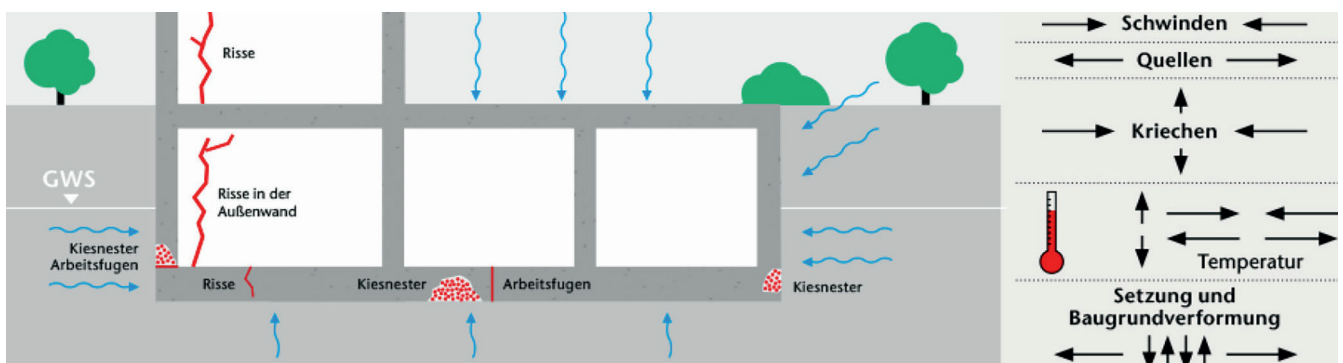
Beanspruchungen und mögliche Betonschäden an Bestandsbauten [21]
